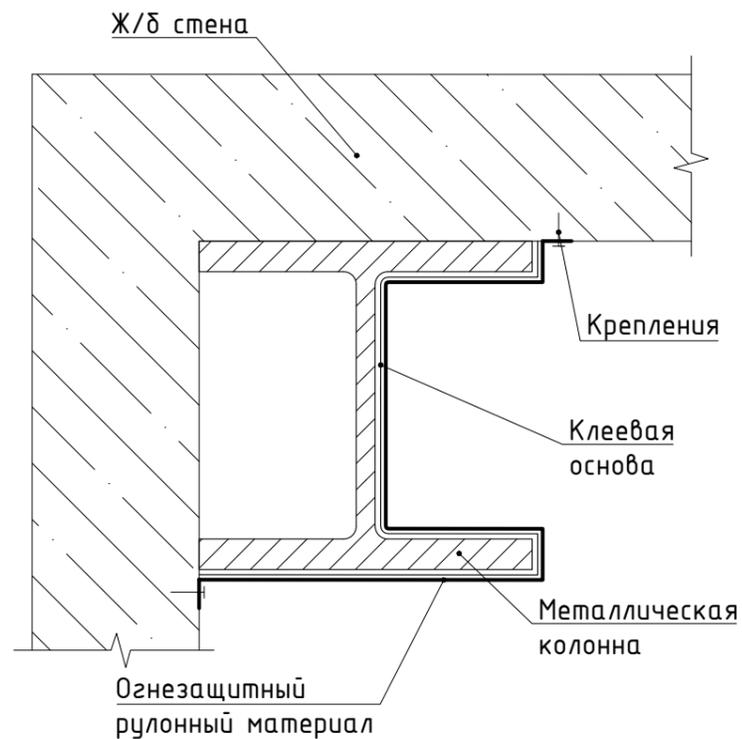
Огнезащита рулонными материалами металлической колонны, двумя сторонами примыкающей к железобетонной стене
